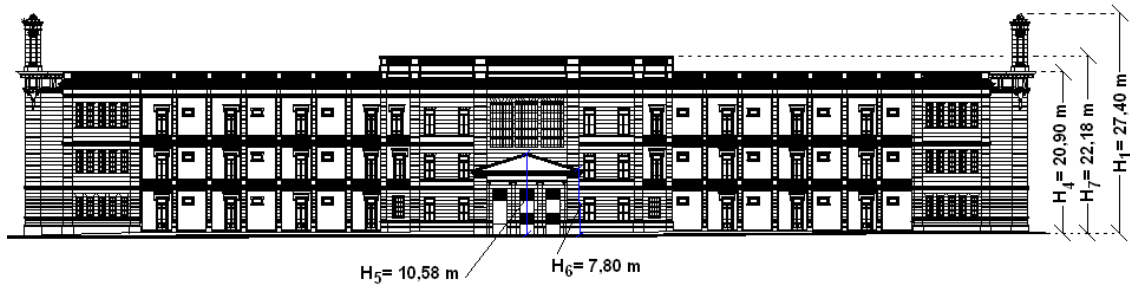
Vista de la fachada posterior del edificio del Colegio Nacional.
